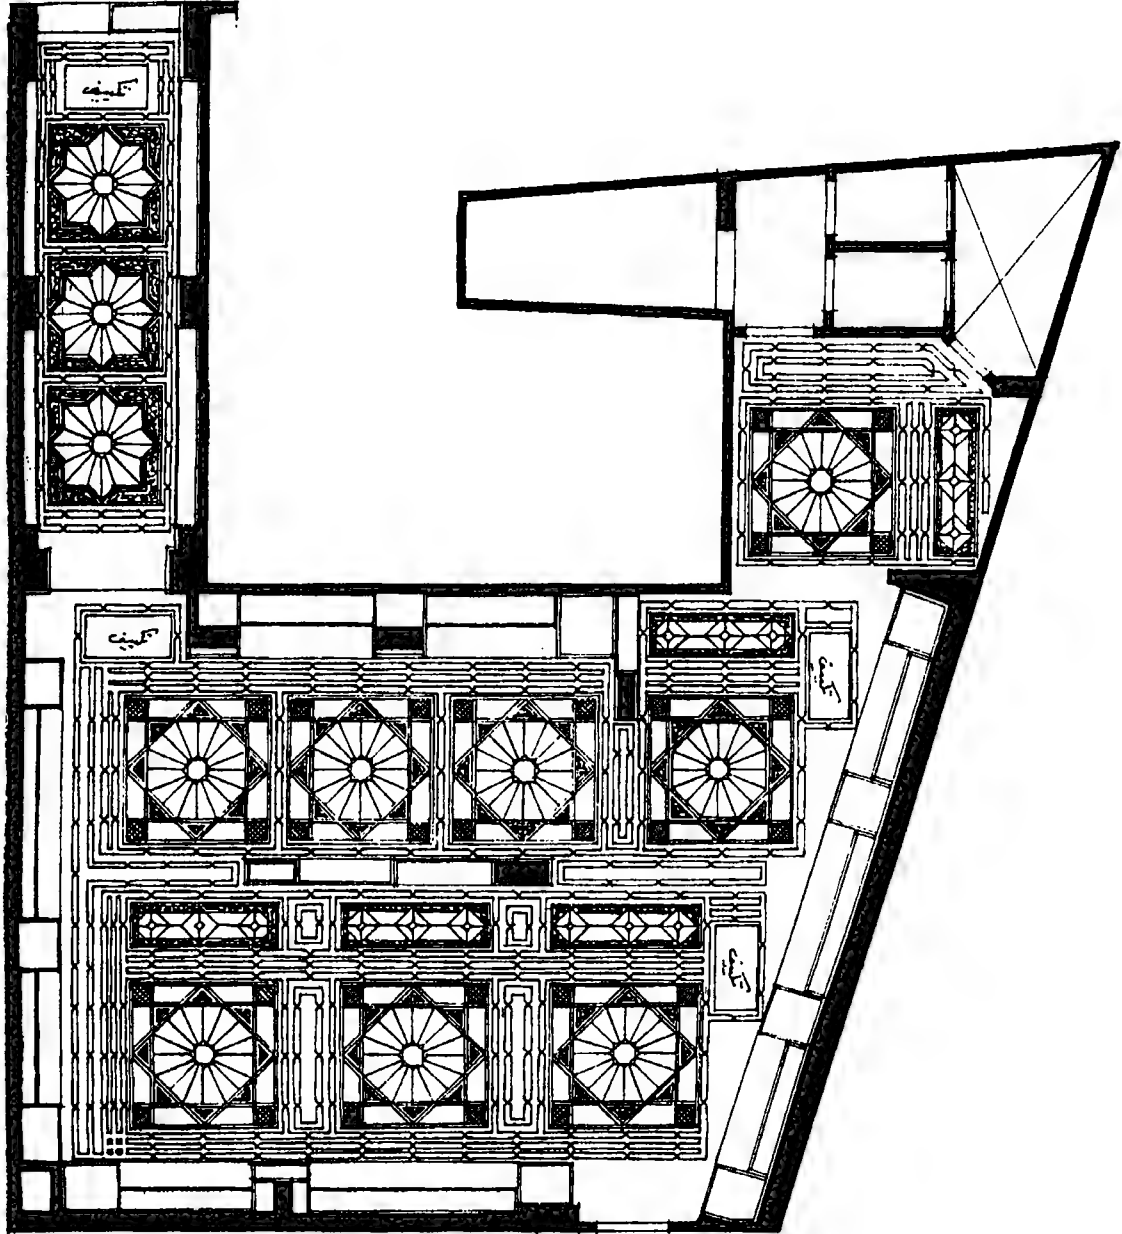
مسقط أفقي سقف خشبي لمحل سياحي أمام ميدان أبو الهول بالهرم
